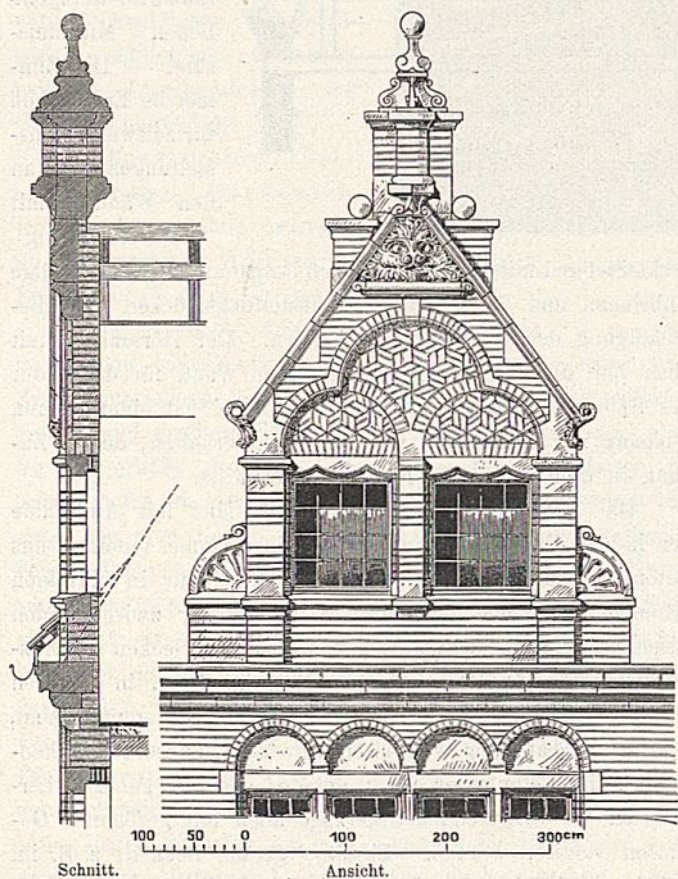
Steinerner Dachaufbau der Vorderfront.
